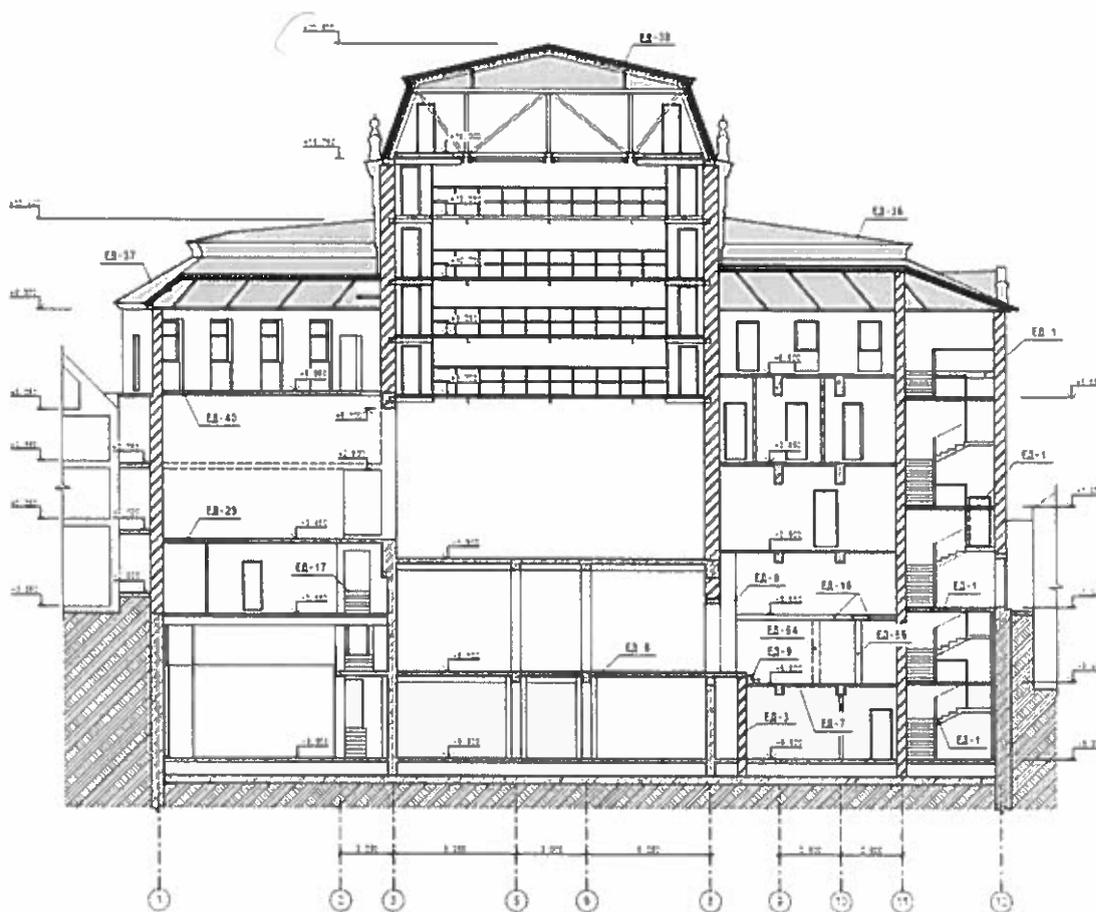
Переріз по будівлі 3-3 [2]
